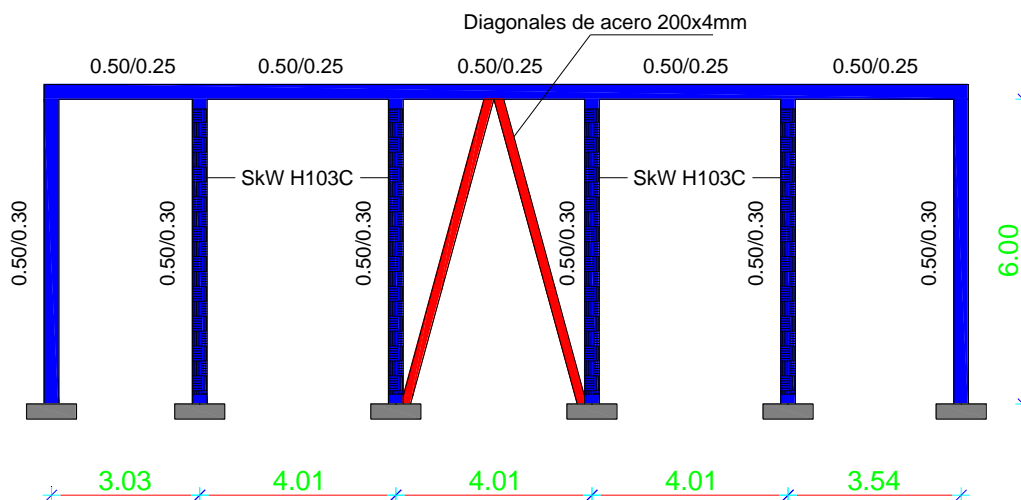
Plano de reforzamiento de pórticos longitudinales
